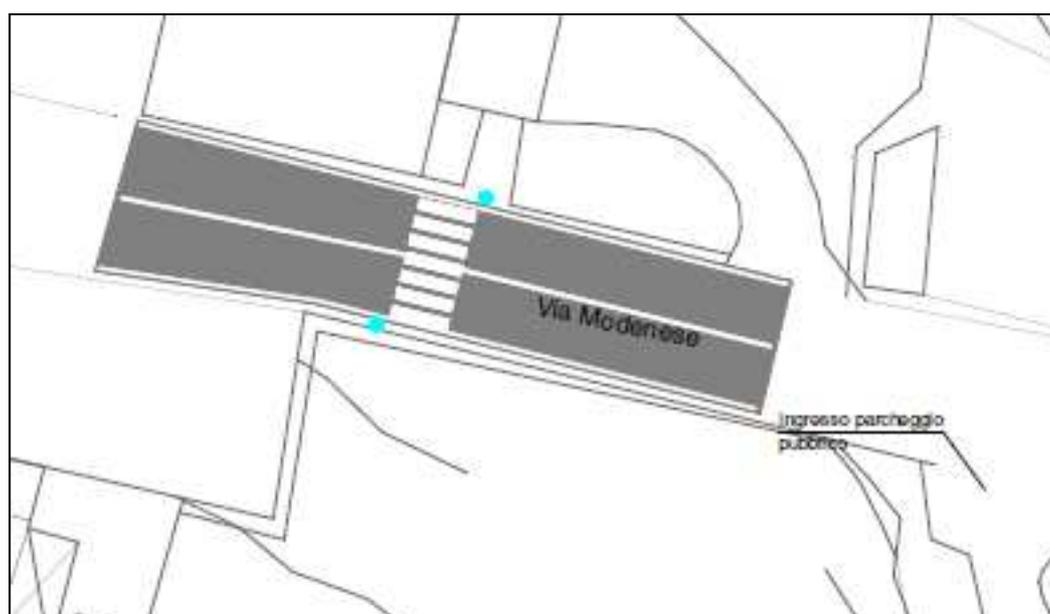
Stato di Progetto Via Modenese – Loc. Piazza - Planimetria
